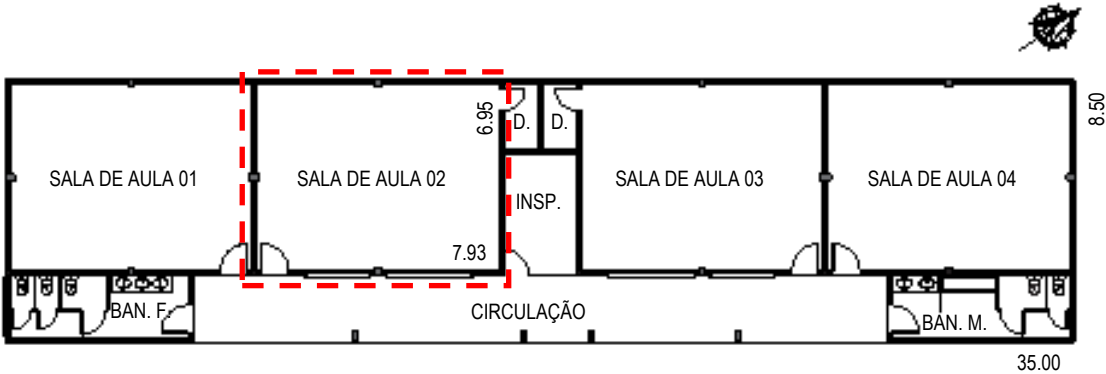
planta baixa do prédio 102 com a indicação da sala de aula usada como referência para a área de ventilação.
